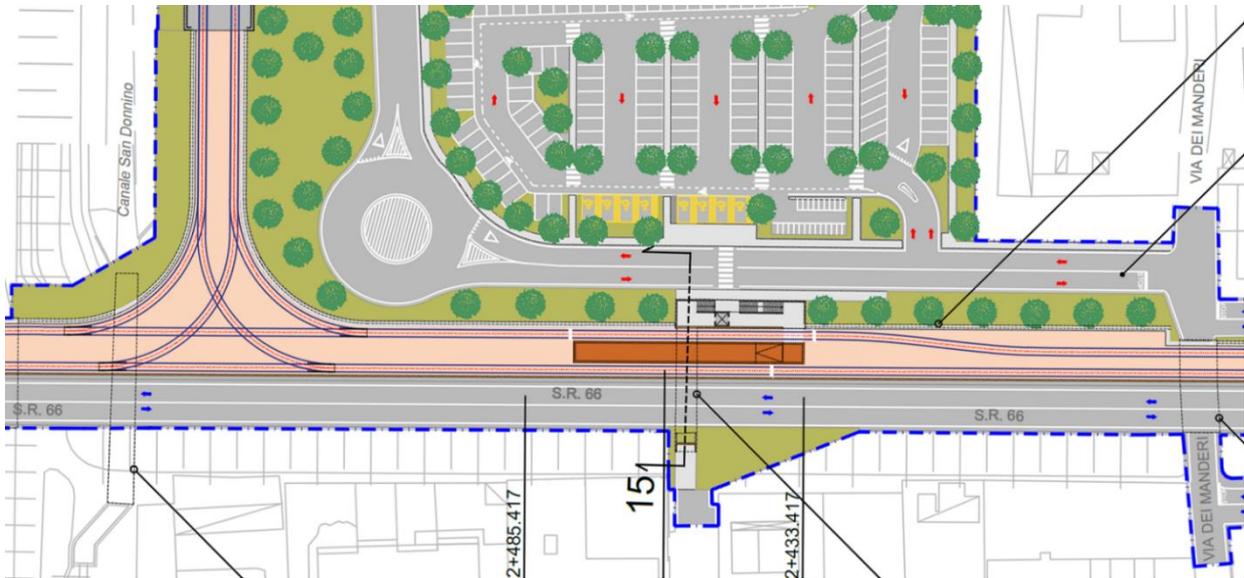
Fermata Pistoiese – Planimetria di insieme
